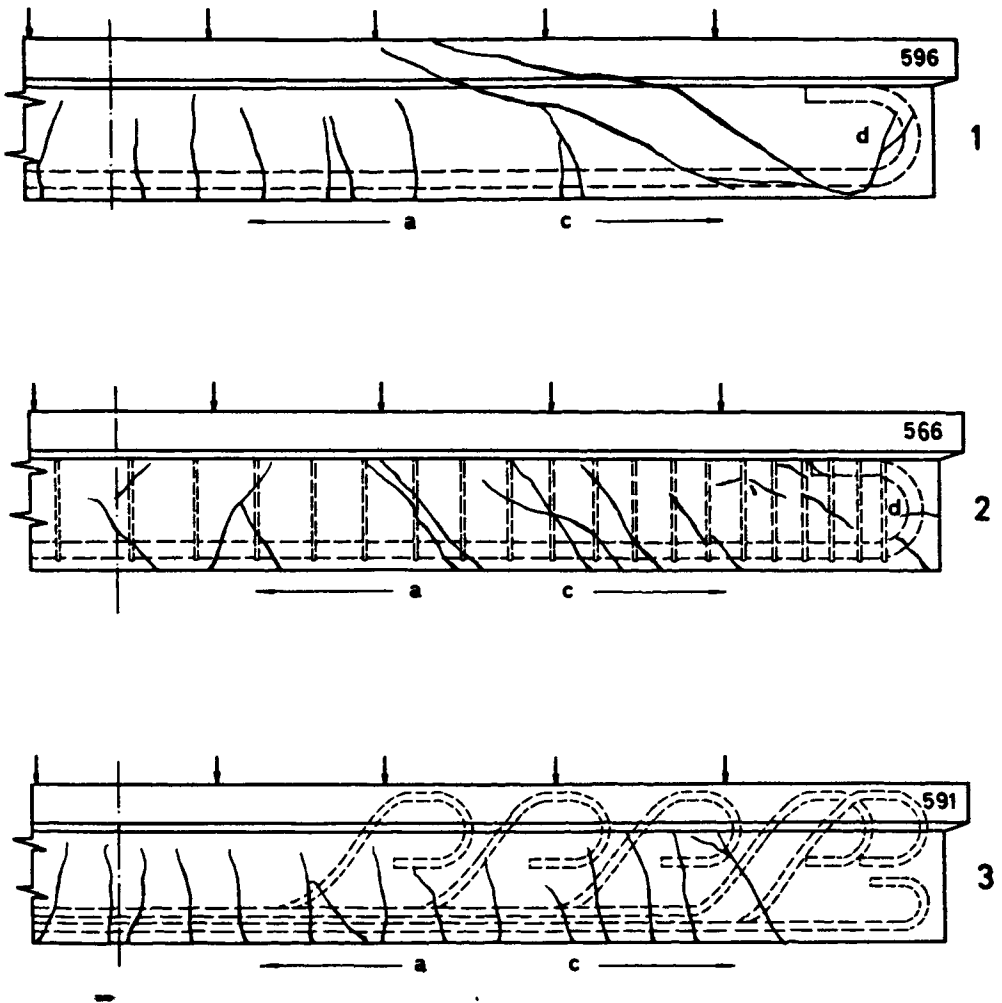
Ensayos de vigas a la flexión. 1, Viga sin armadura transversal. 2, Con estribos. 3, Con barras levantadas. Las grietas *a* son de flexión, las grietas *c* de tracción diagonal y las grietas *d* (casos 1 y 2) de adherencia. Experiencias de la Comisión Alemana para el Hormigón Armado, cuaderno 20, citadas por Mörsch²¹.
